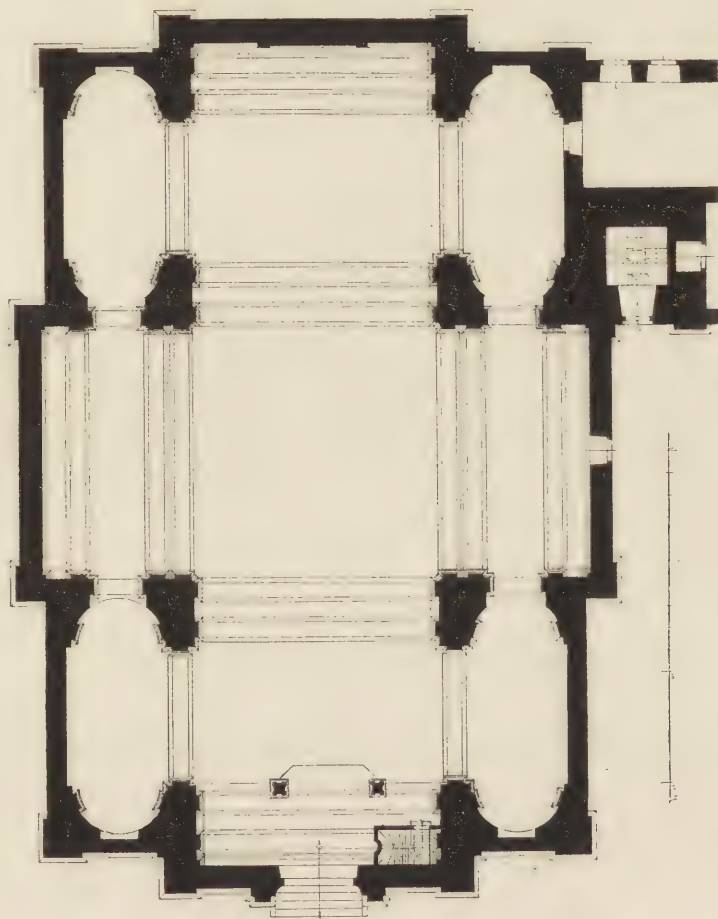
Konviktskirche zu Ehingen. Grundriss.
